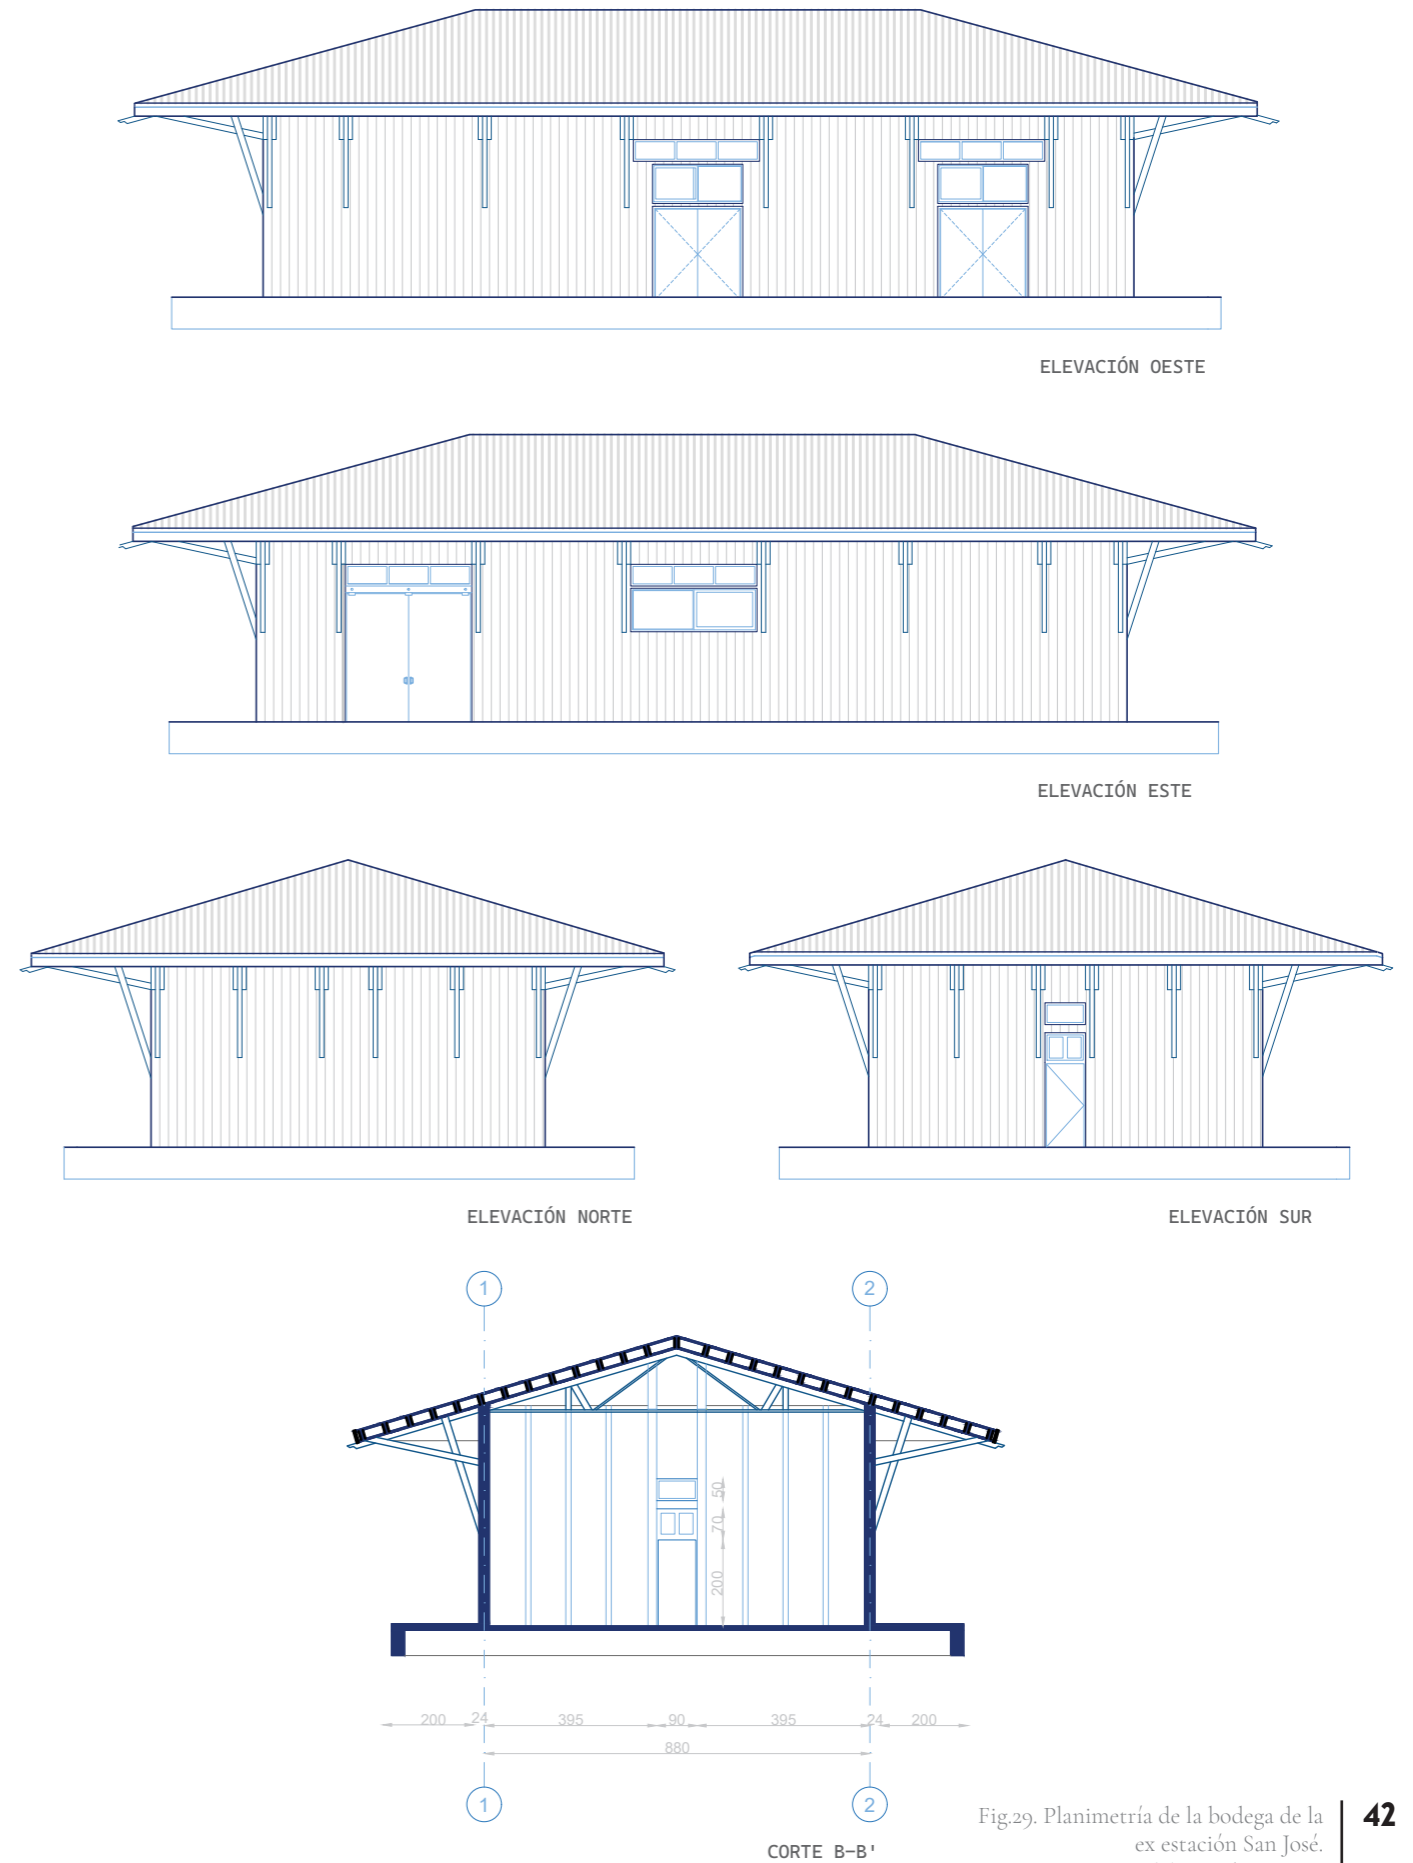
Planimetría de la bodega de la ex estación San José. Fuente: Elaboración Propia.
